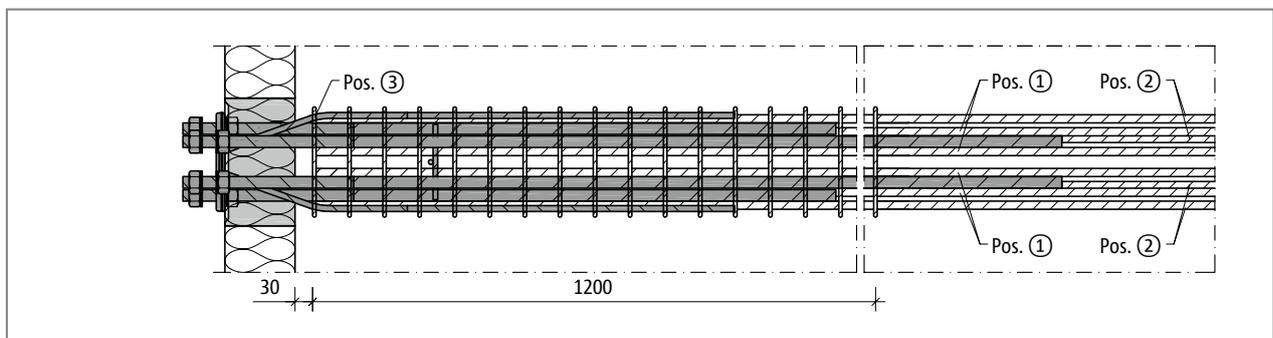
Schöck Isokorb® XT Typ SK-MM2: Bauseitige Bewehrung, Grundriss
